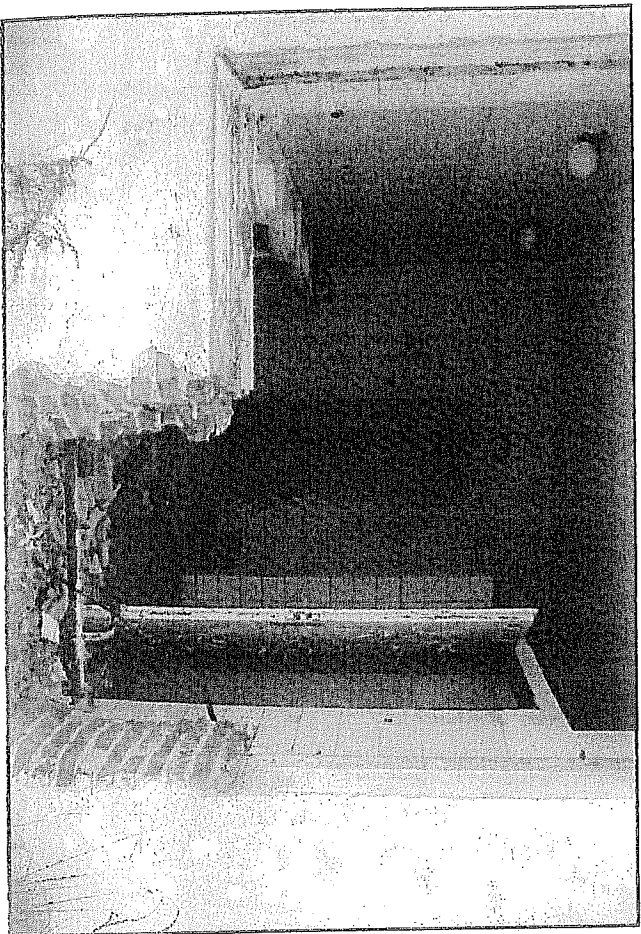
Sklady, šatna a umývárna TD - detail (parc. č. st. 3813/74).
